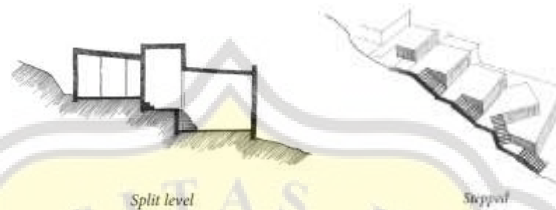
5 Gambaran Bentuk Massa Bangunan
